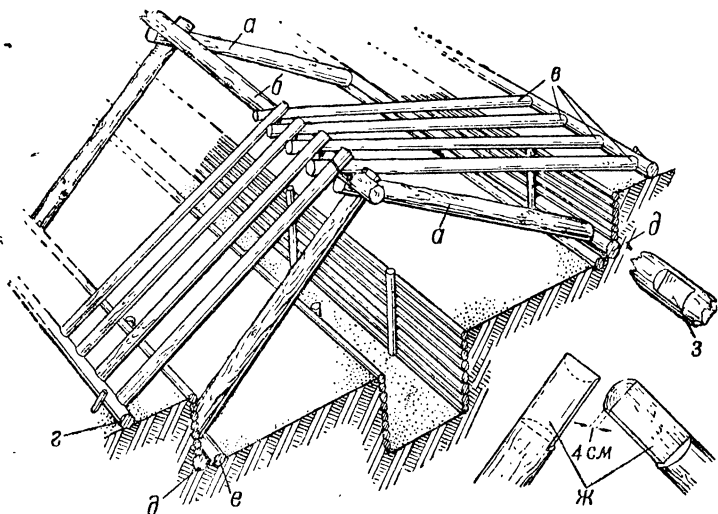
Схема перекрытия землянки на козелковых опорах:
